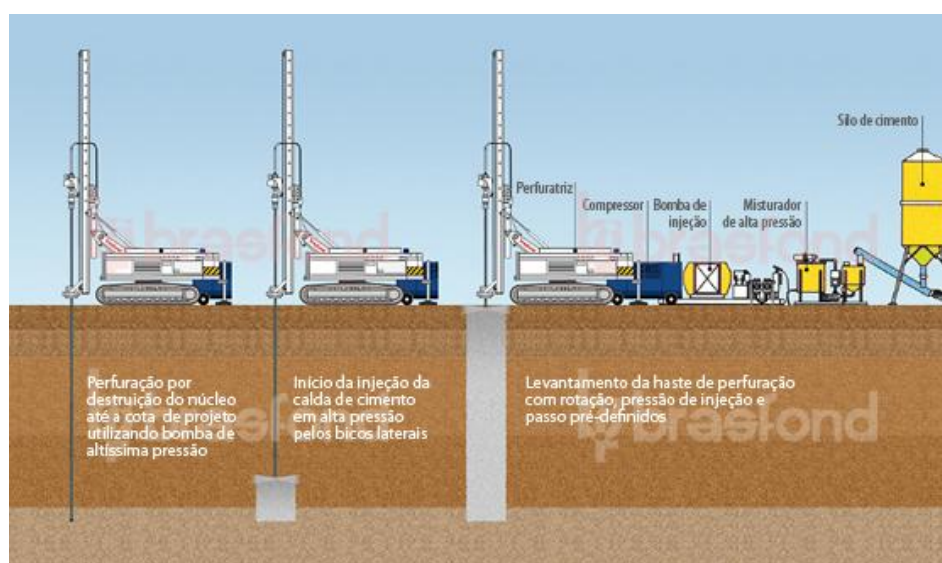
Execução de *jet-grouting* (site: brasfond, 2012).
